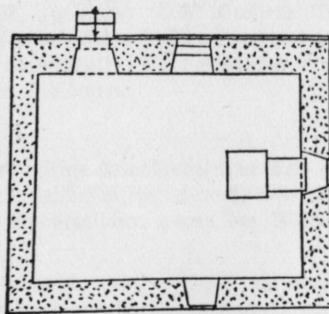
Hemmighausen, Grundriß der Kapelle. 1 : 200
